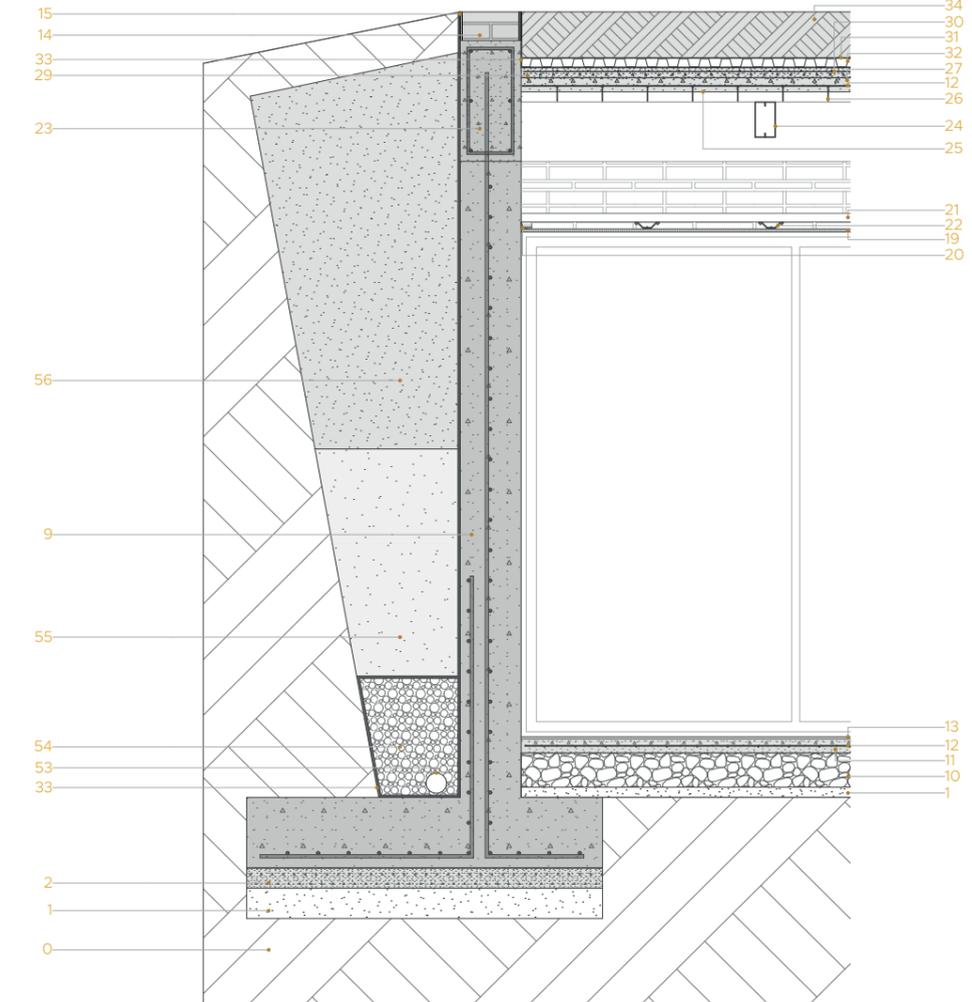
\_C4: sección constructiva\_06, muro contención, sala tanatopraxia y construcción
